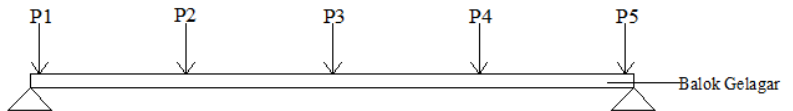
13 Beban Suri Pada Plat (Tampak Depan)
